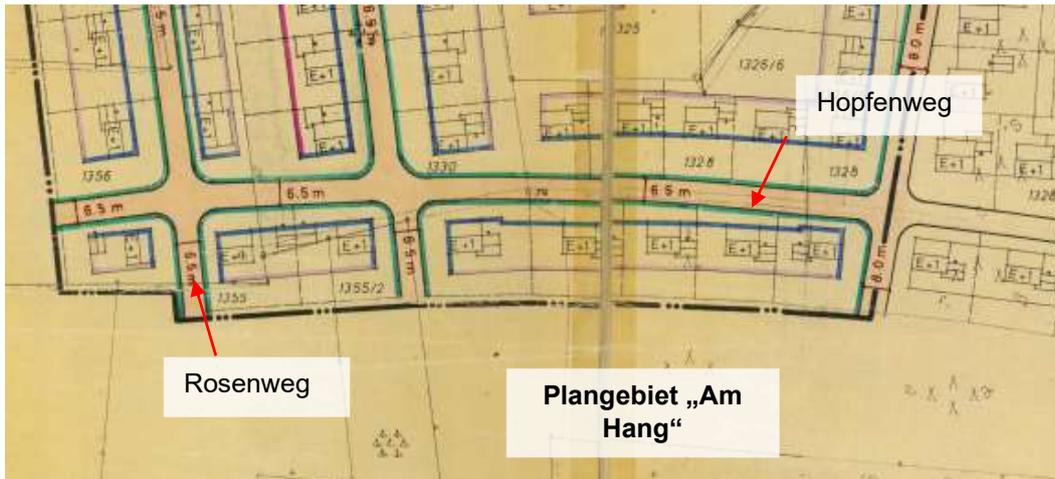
Ausschnitt Planzeichnung BP „Hopfenweg bis Zieglerstraße“
